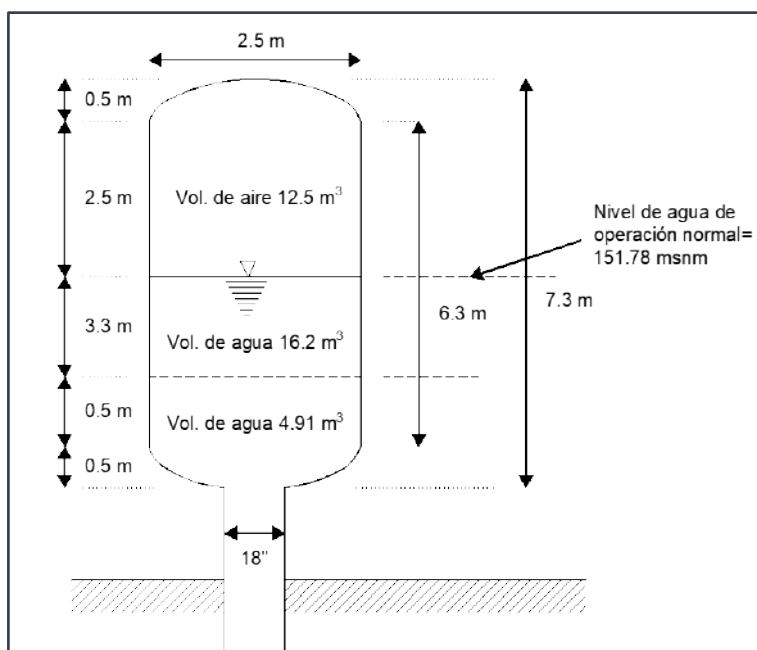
Cámara de aire para protección del tramo planta potabilizadora a rebompeo No. 1
